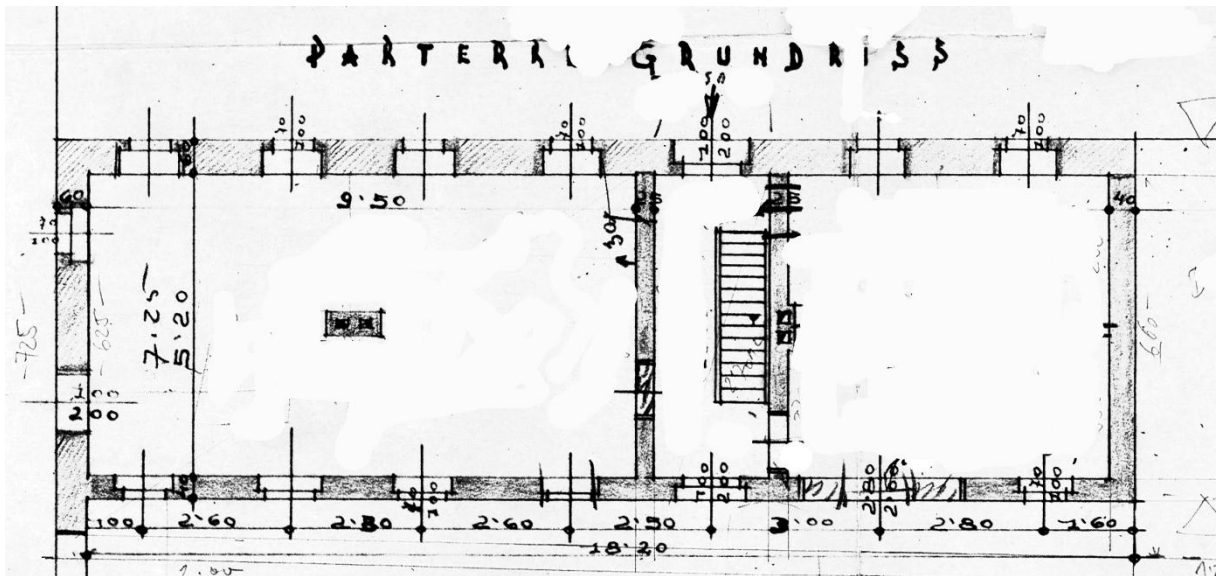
Grundriss Erdgeschoß (Bestand)
